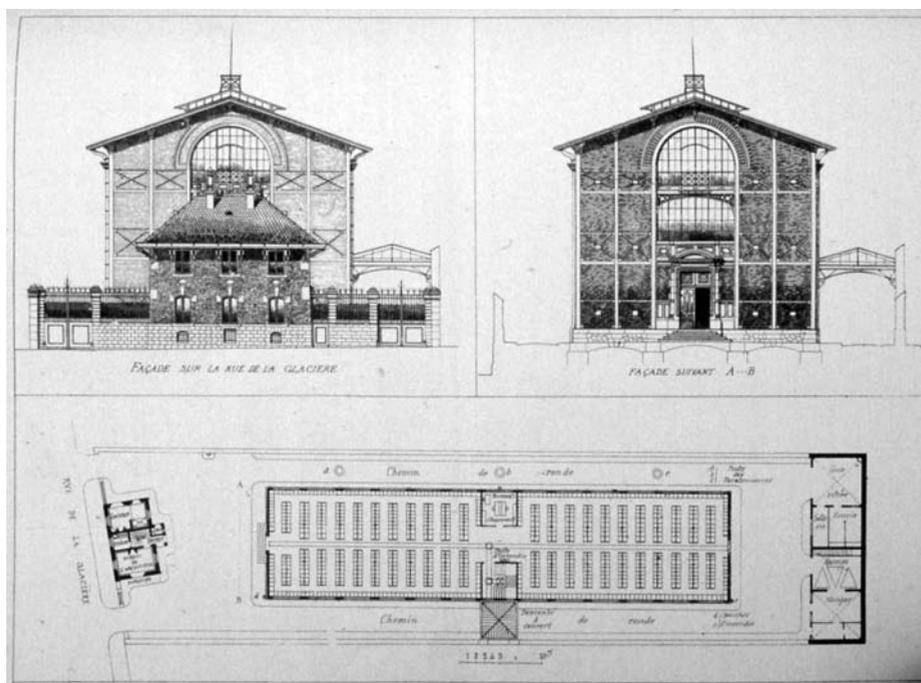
Façade du bâtiment des archives du Crédit Lyonnais sur la rue de la Glacière («La Construction moderne», 20 juin 1891, pl. 70).
